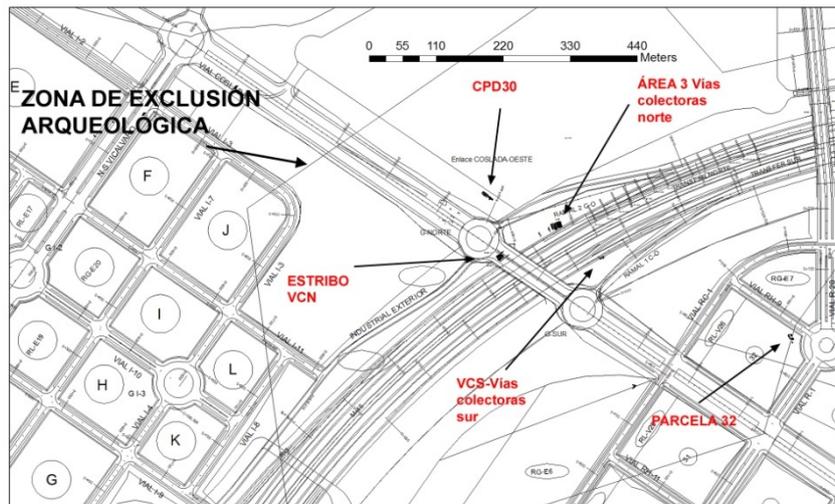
Planimetría de sondeos y áreas excavadas en el Cañaveral.
